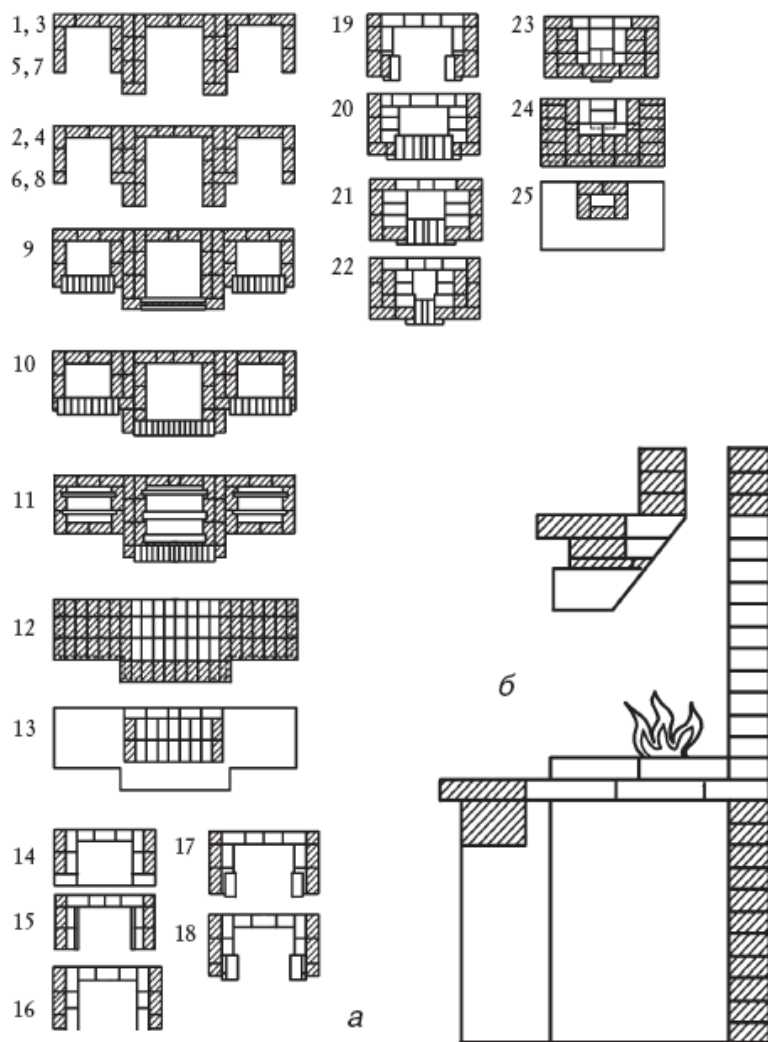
Конструкция камина: а – порядовка; б – разрез
